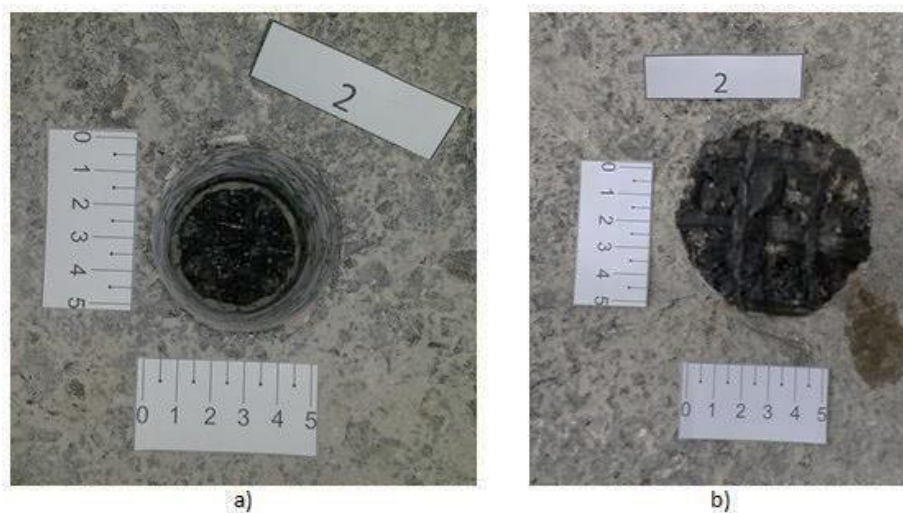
Rotura do provete A2 da obra A após ensaio de tração *Pull-off
